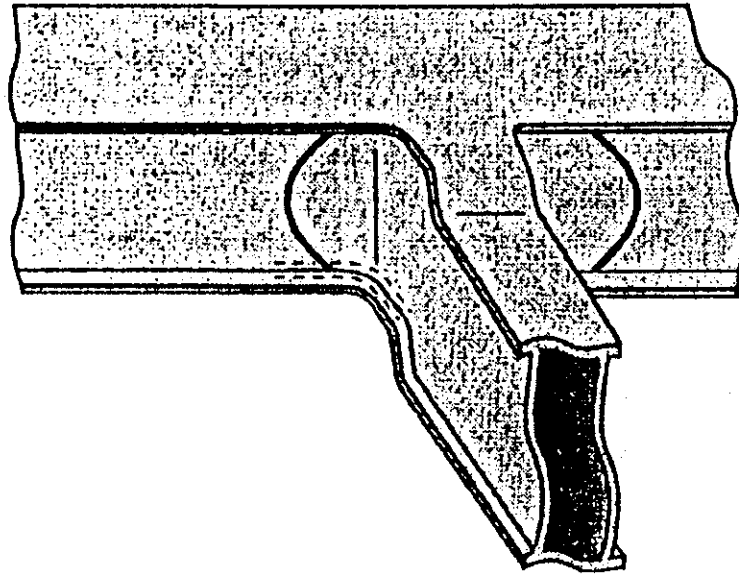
Контроль сварных швов соединения верхних и нижних стенок с боковыми стенками
